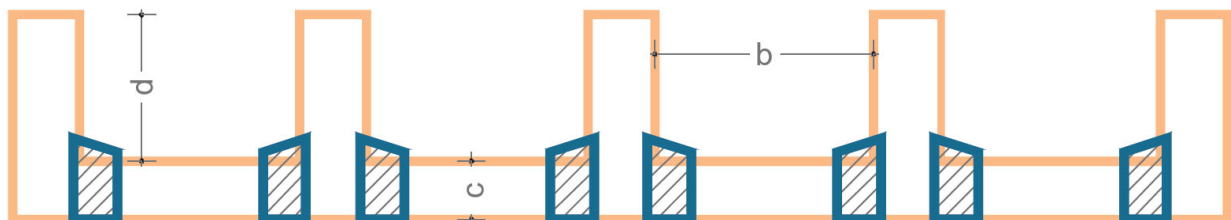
ipotesi della configurazione planimetrica del paramento murario a contrafforti.
